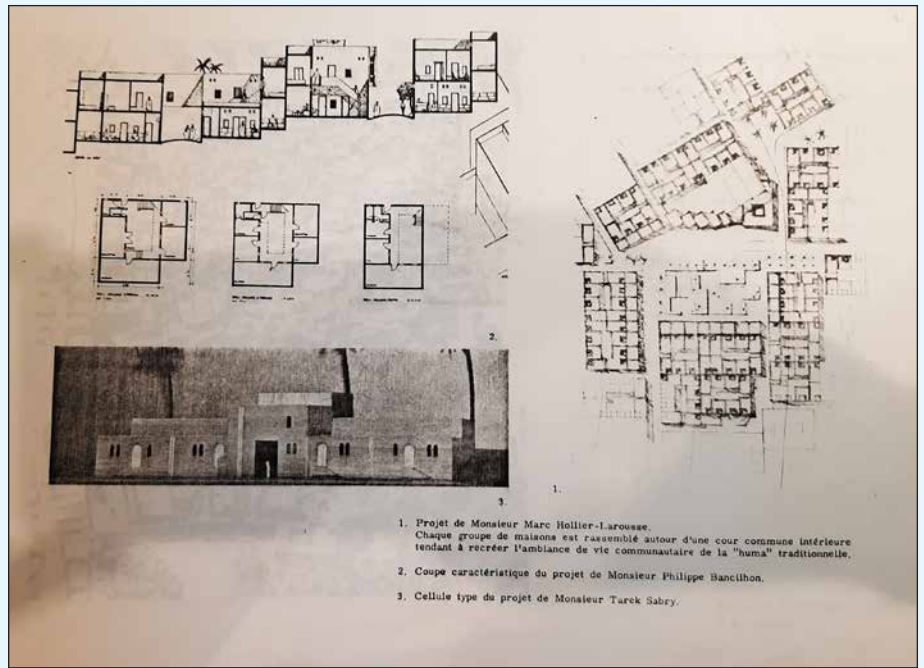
à 31. Planches extraites de « Ecole d'architecture sept. Voyage au Maroc. Mars-avril 1984 », juin 1984. Projets des étudiants pour le secteur populaire de Salé-Tabriquet. AN : 20050601/347. De haut en bas : plan masse de Marc Hollier-Larousse, coupe de Philippe Bancilhon, et perspective de Tarek Sabry ; planche 2, projets d'Eric Wolfs et de J.M. Chailloux ; planche 3, projet de Christophe Bente.
